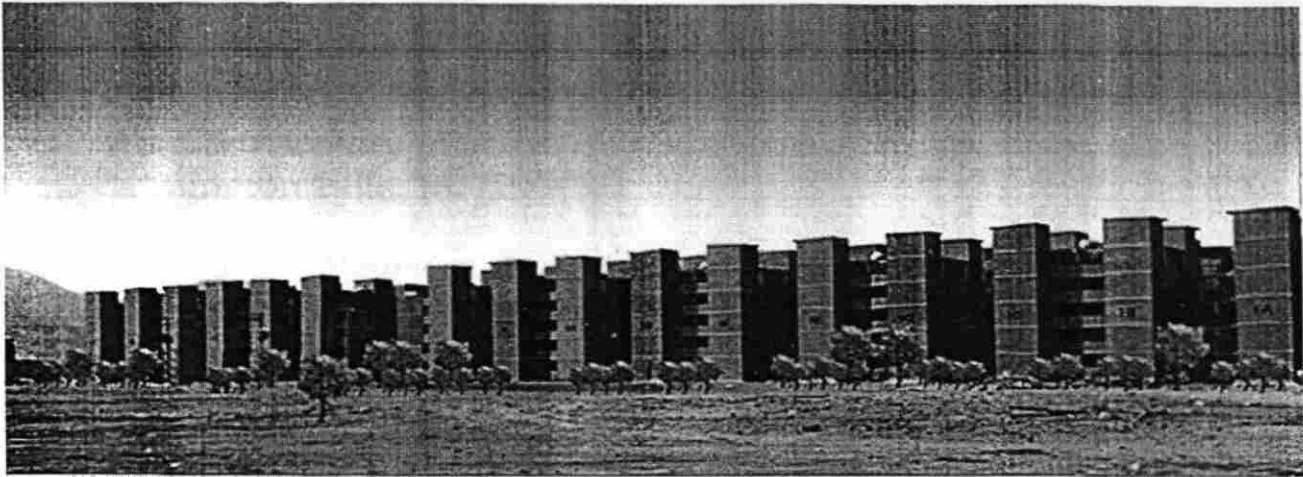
Construcciones comunes con mampostería reforzada.
